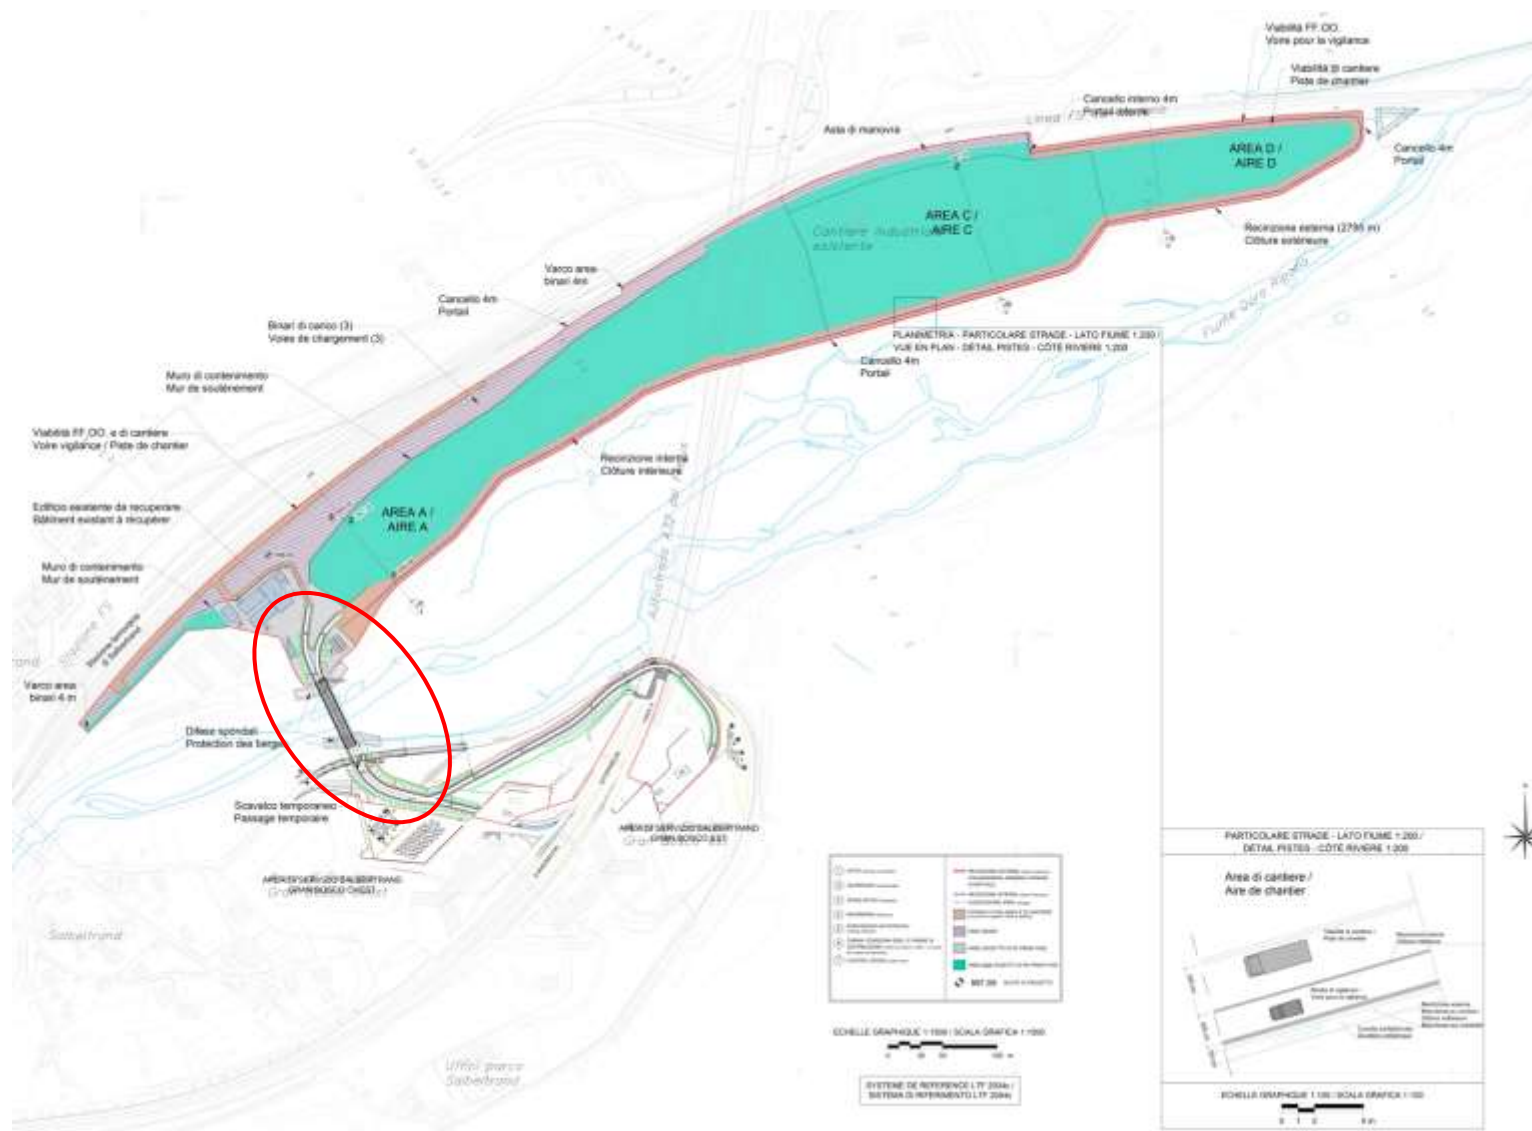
Planimetria area di cantiere di Salbertand in esercizio.
